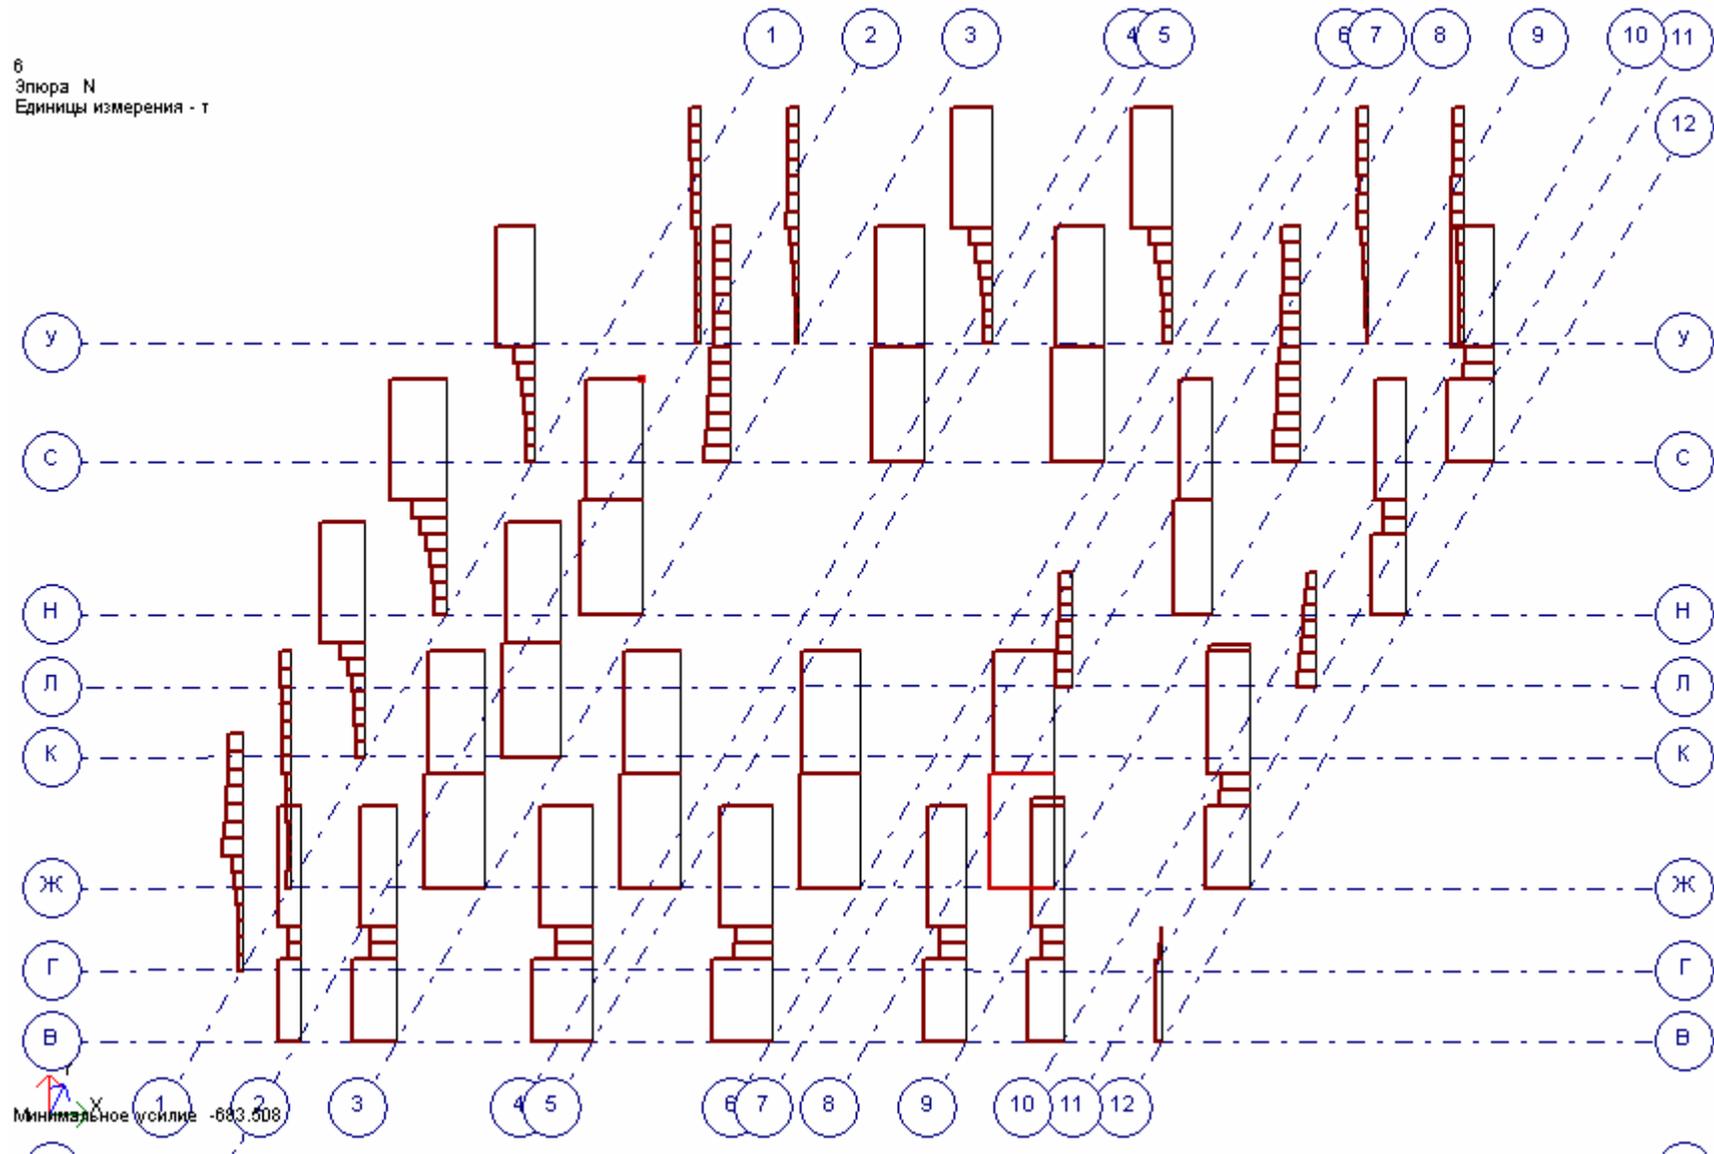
Эпюры для колонн, примыкающих к первому этажу
